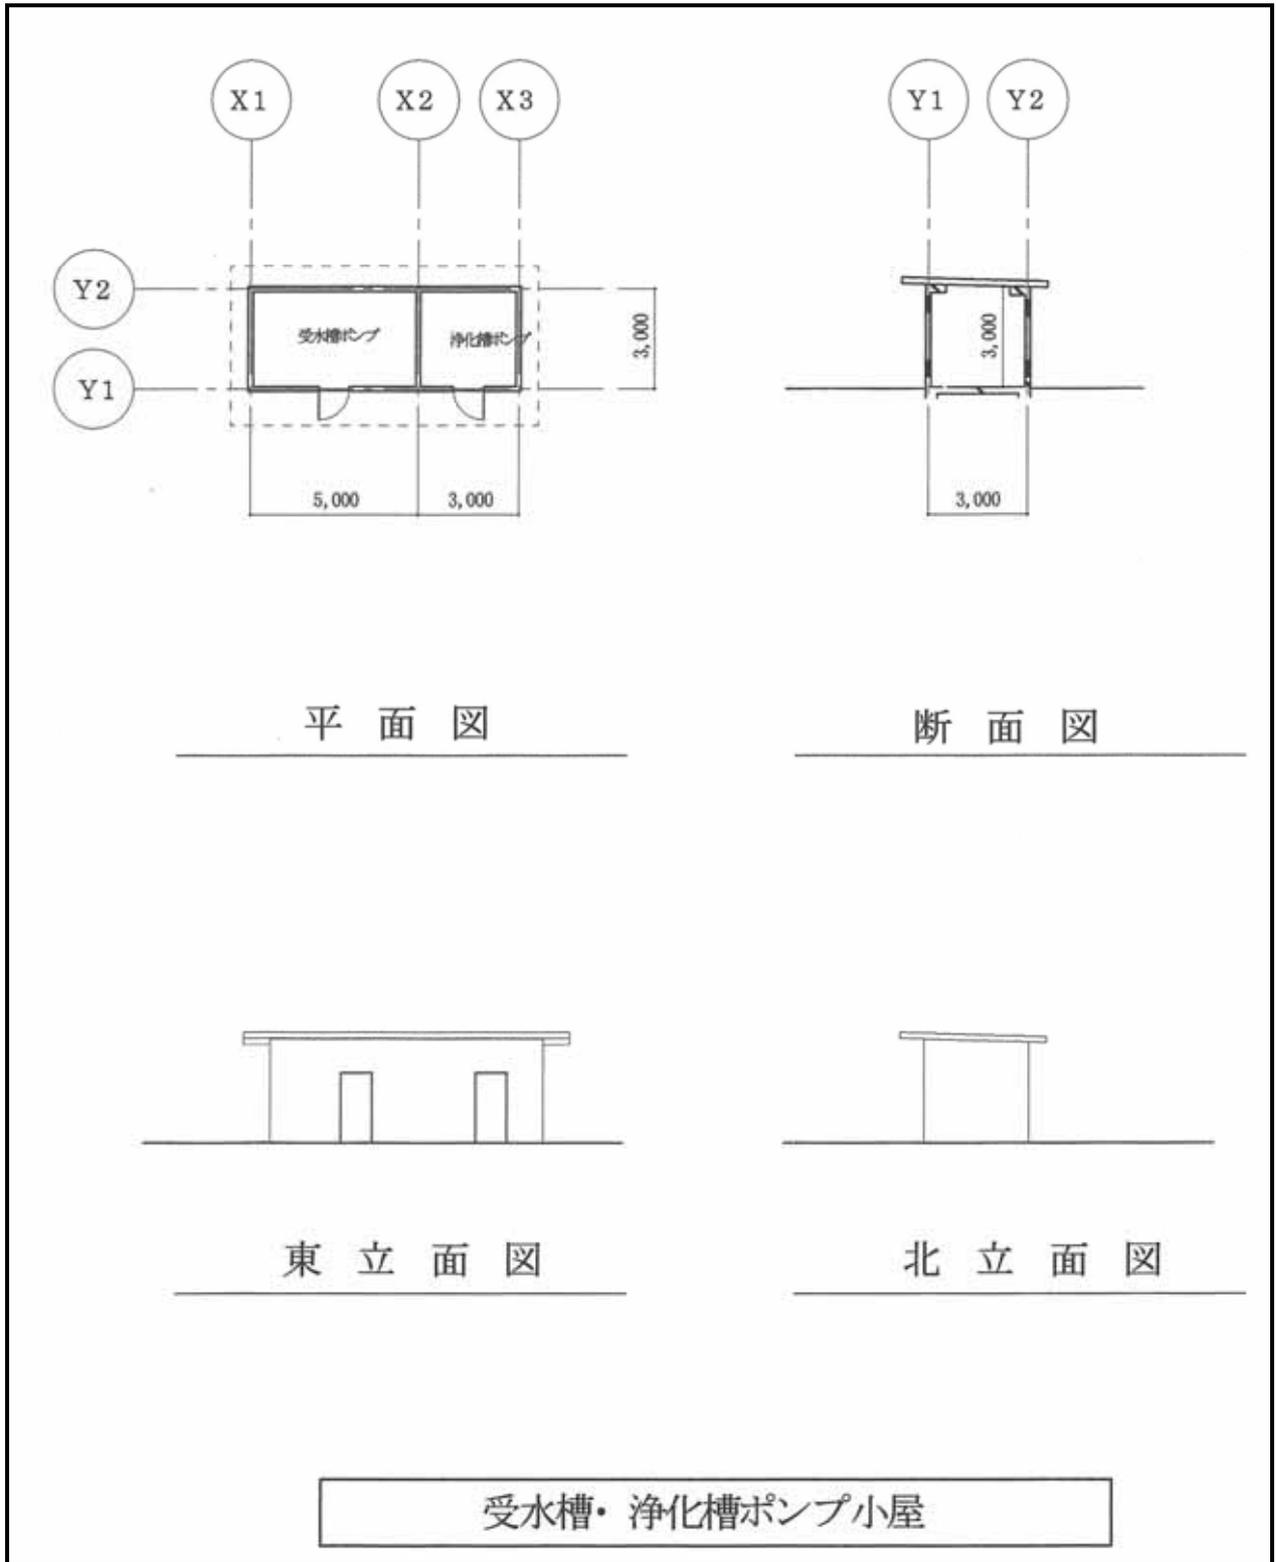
受水槽・浄化槽 平面・断面・立面図
